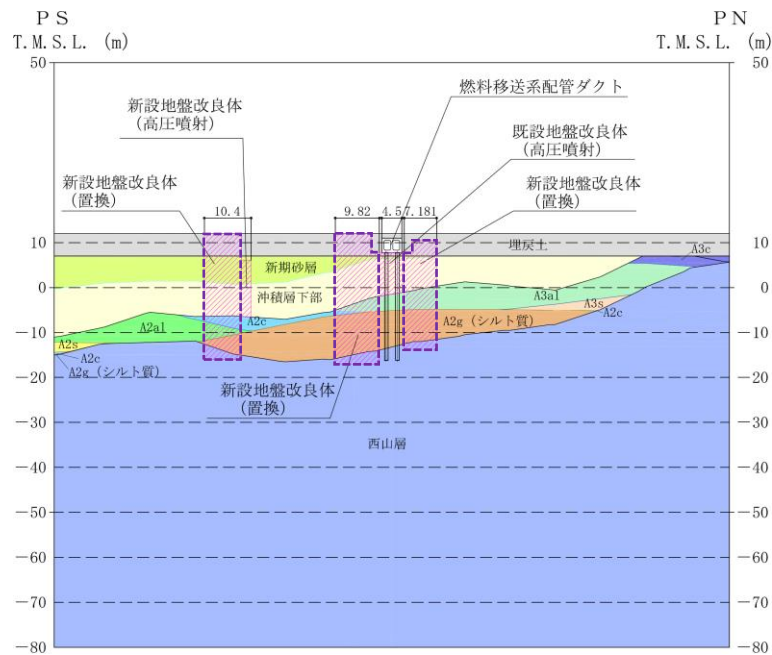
軽油タンク基礎 (6号機設備) の地盤改良体配置図 (構造物拡大図)
